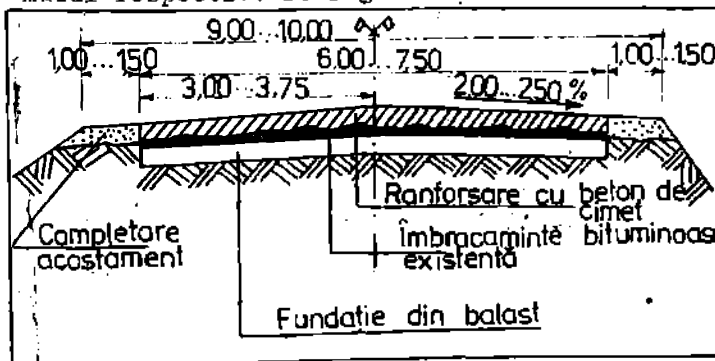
Secțiune transversală a unui drum ranforsat cu îmbrăcămînți din beton de ciment.
